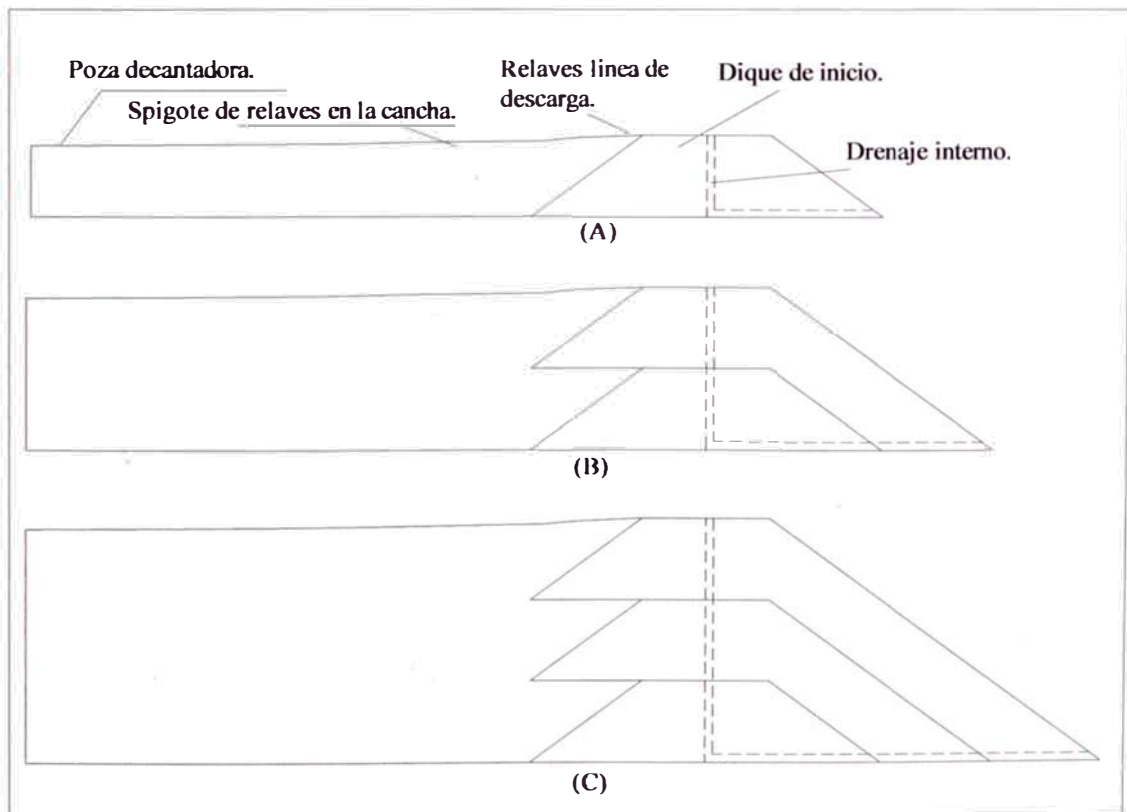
Secuencia de sobre elevación. Presa construida con el método "Línea Central" y dren de chimenea.
